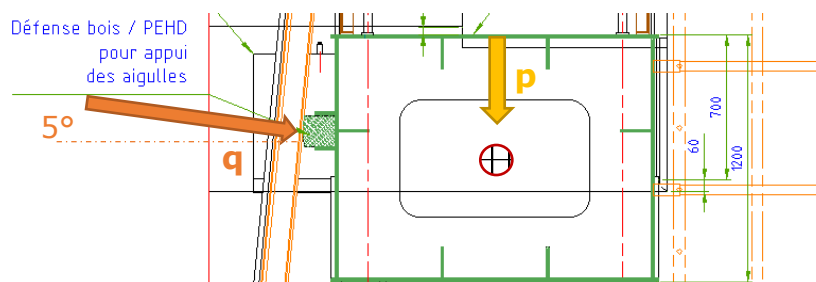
Schéma d'application des efforts sur poutre (passe amont)
